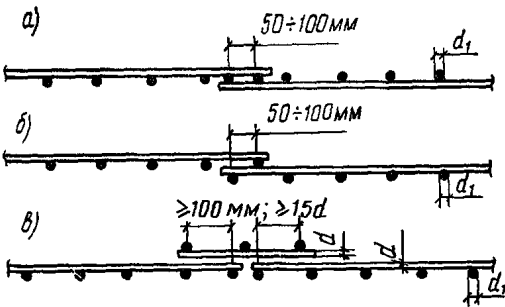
Стыки сварных сеток в направлении распределительной арматуры
